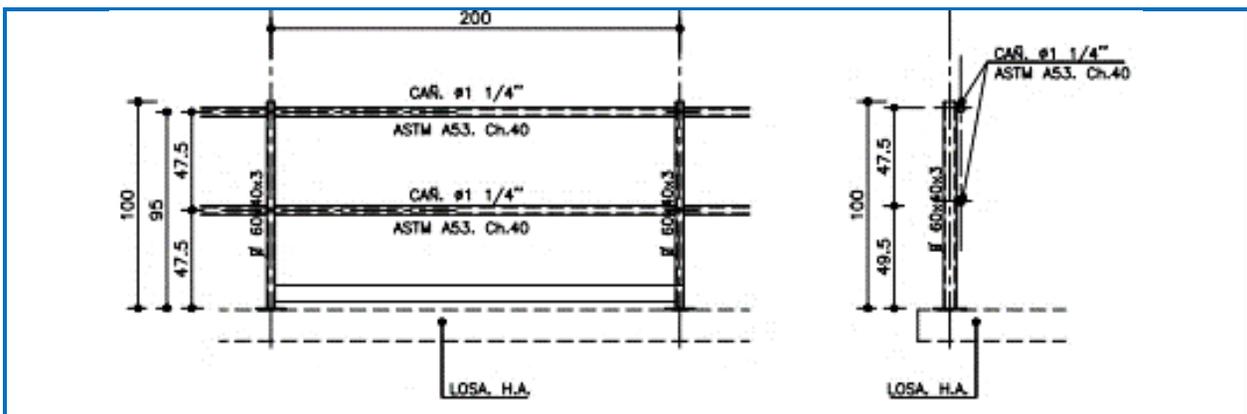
Baranda modular de perfil cuadrado metálico vertical 60x60x3 y largueros horizontales metálicos de Ø1 1/4" (medidas en cm)- Elaboración Propia
